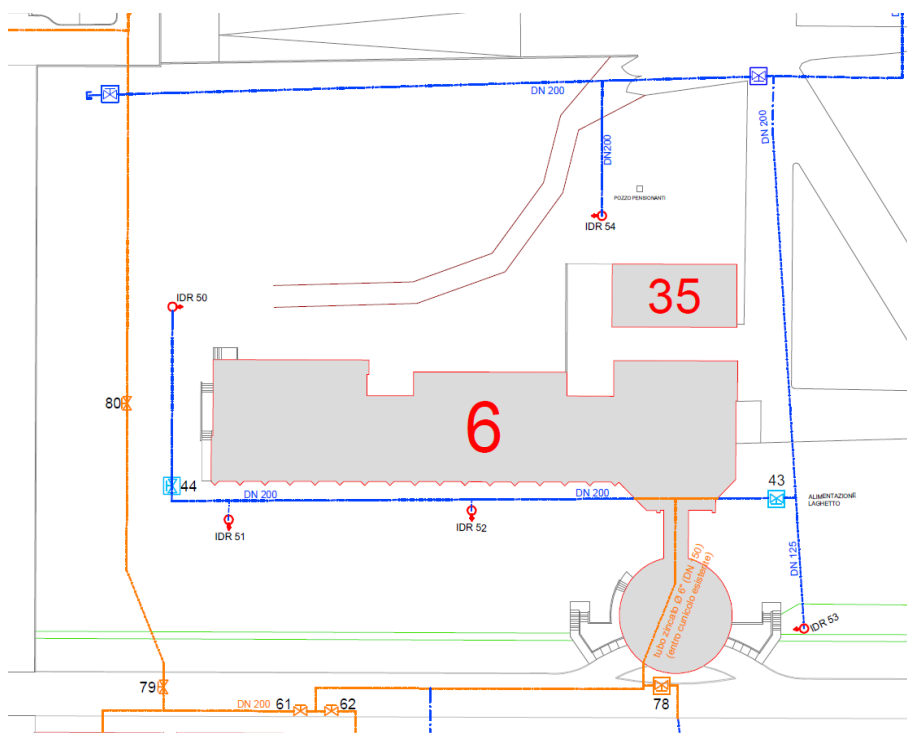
Planimetria del lotto indicata la rete fognaria esistente (in blu)
